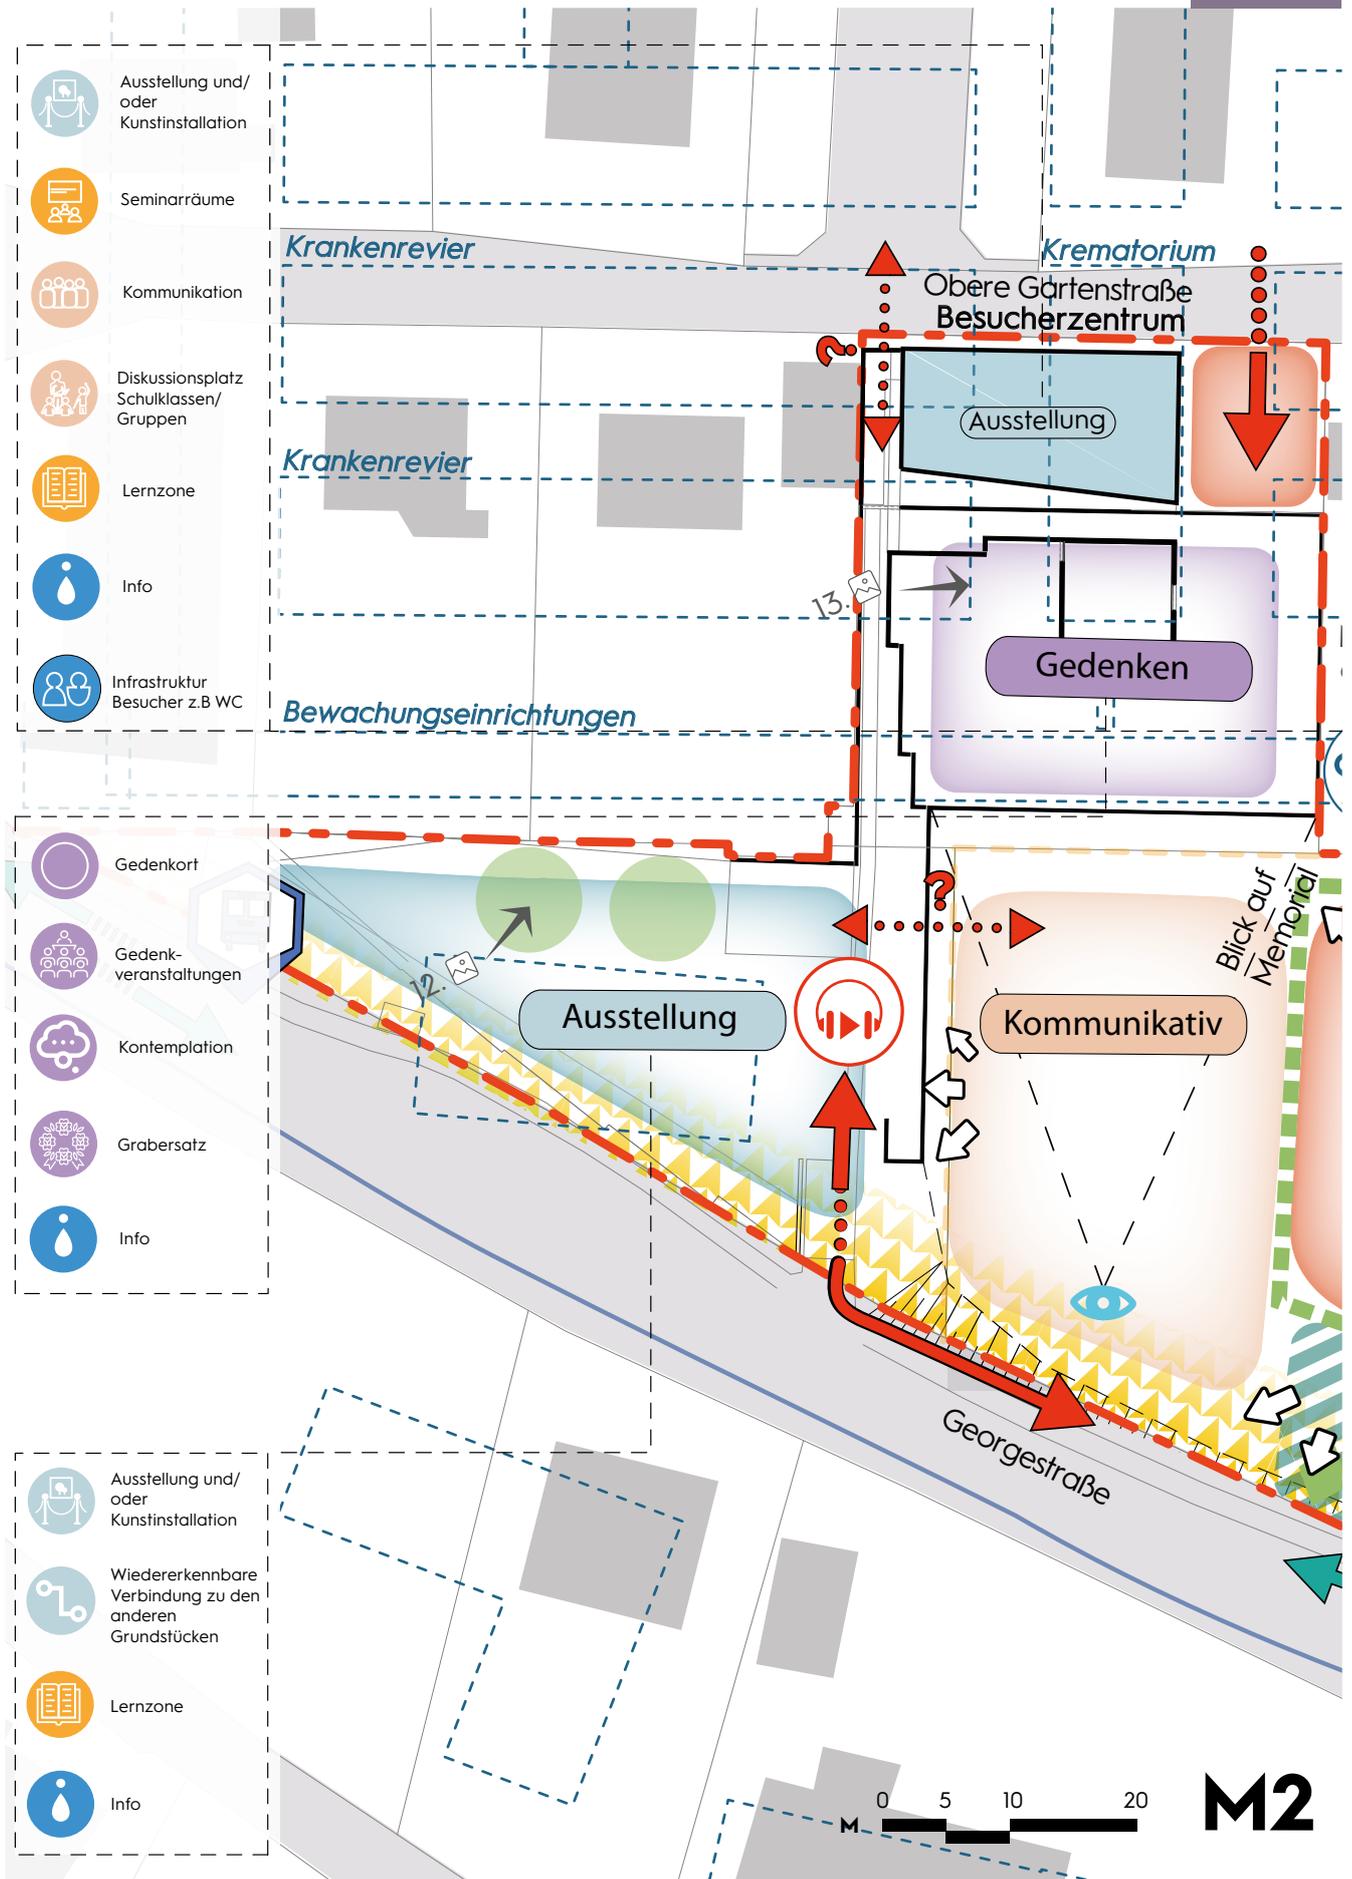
Masterplan Grundriss Memorial (Ausschnitt M2)
